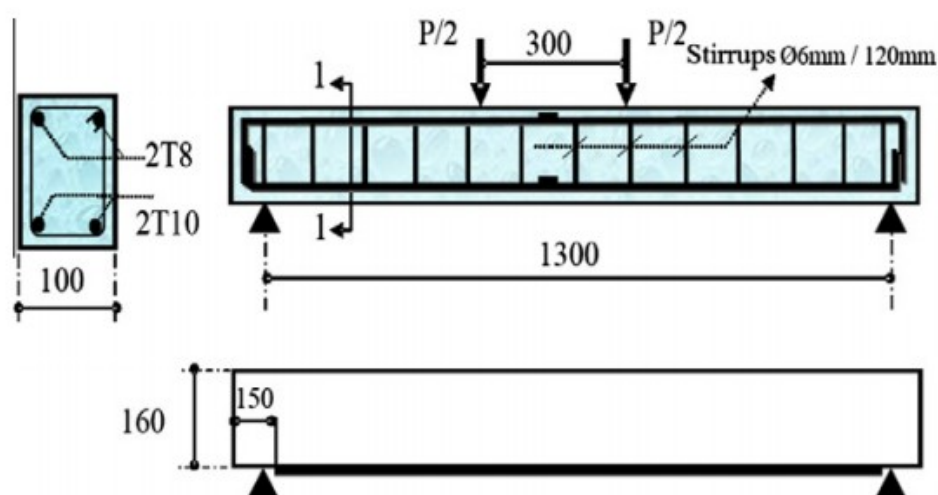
Dimensions et chargement de la poutre en flexion quatre points [3].
